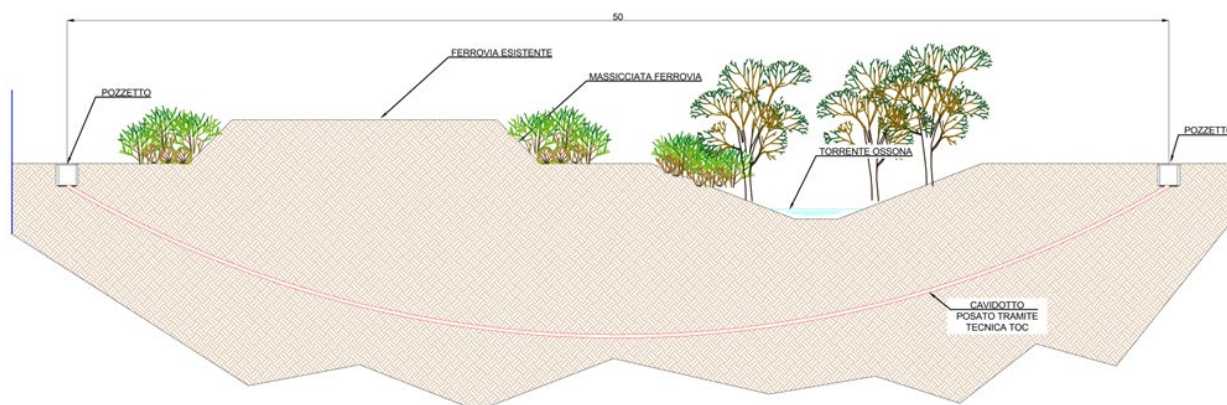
Sezione di attraversamento delle interferenze (linea ferroviaria e T. Ossona).
